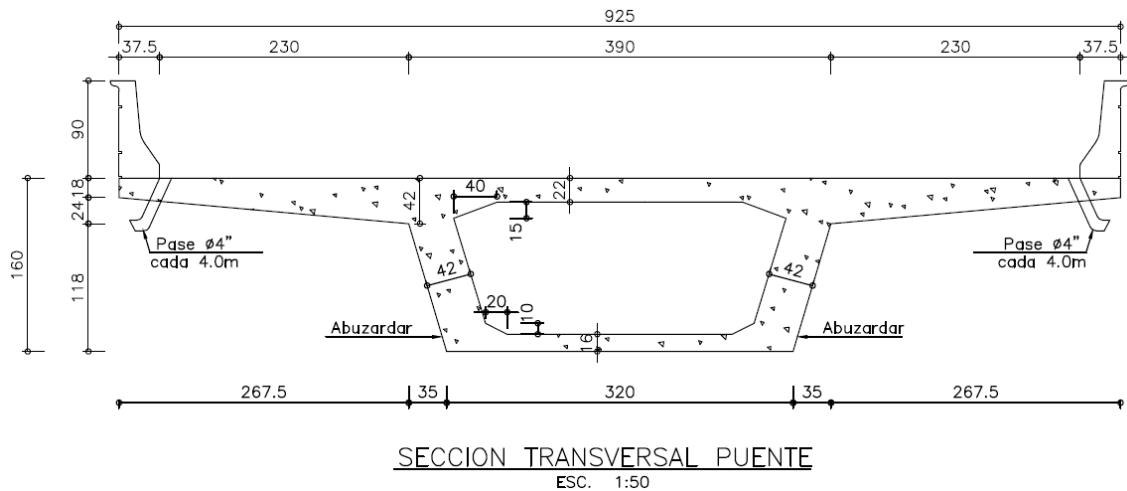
Sección transversal de la superestructura del puente vía a Minca.
